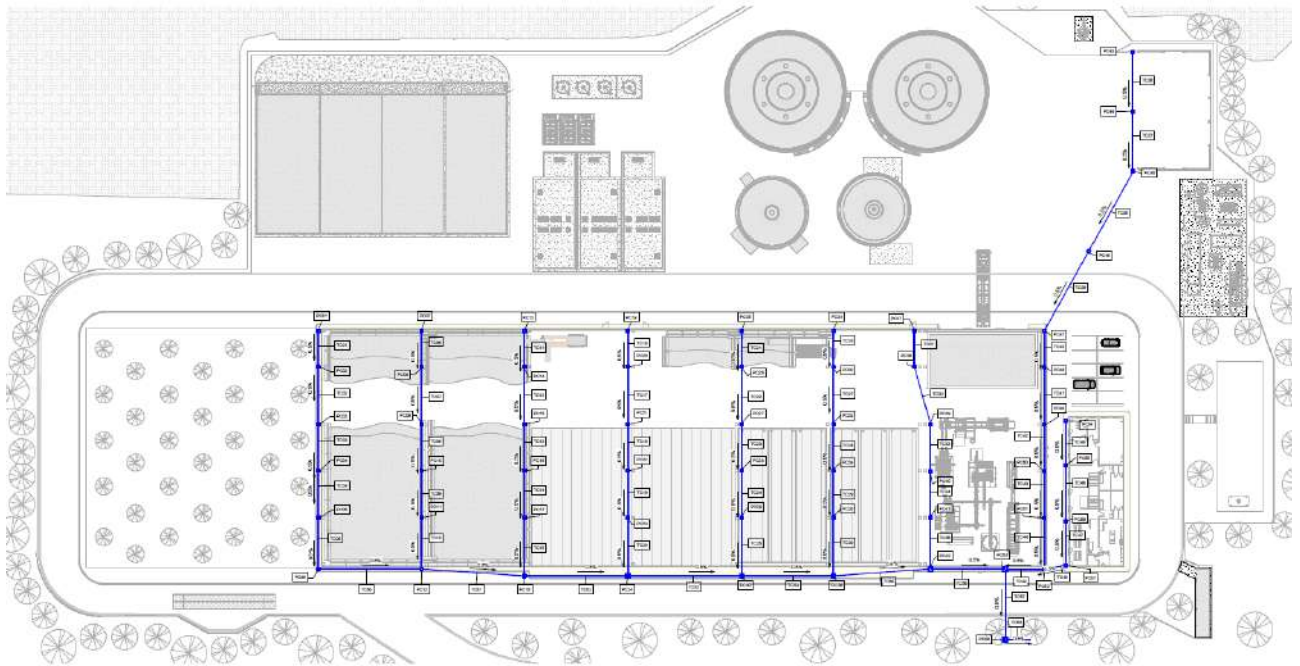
ESE.EGR.MET.006 – Planimetria generale acque meteoriche dalle coperture
